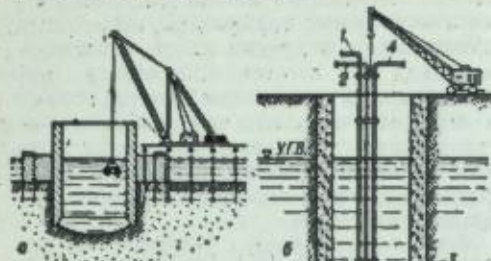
Схема подводной разработки грунта в О. к.: а — островной О. к. (разработка грунта грейфером); б — береговой О. к. (разработка грунта гидроэлеватором); 1 — трубопровод воды для размыва грунта; 2 — трубопровод рабочей воды гидроэлеватора; 3 — гидроэлеватор; 4 — паропровод; 5 — всасывающий пульповод.
